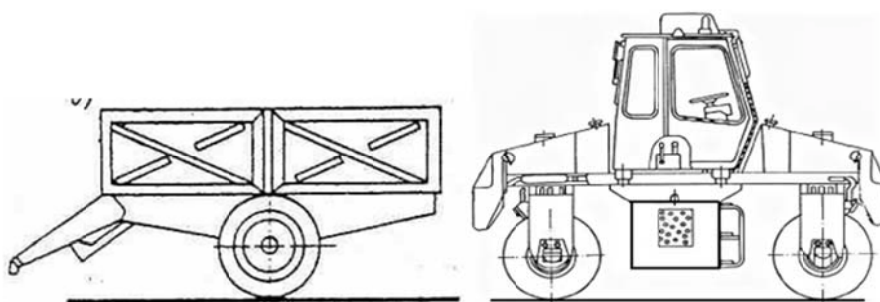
Общий вид прицепного пневмоколесного катка и самоходного
